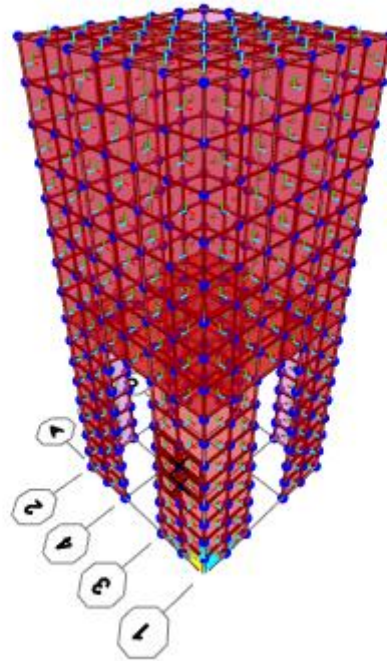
Creación de sección viga 0.5mx0.3m
